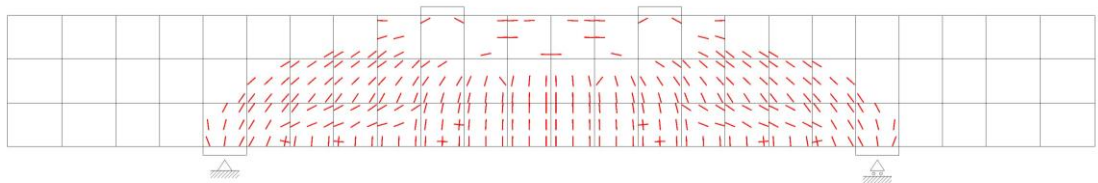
破壊時の変形及びひび割れ状態 (Case No. 9)
